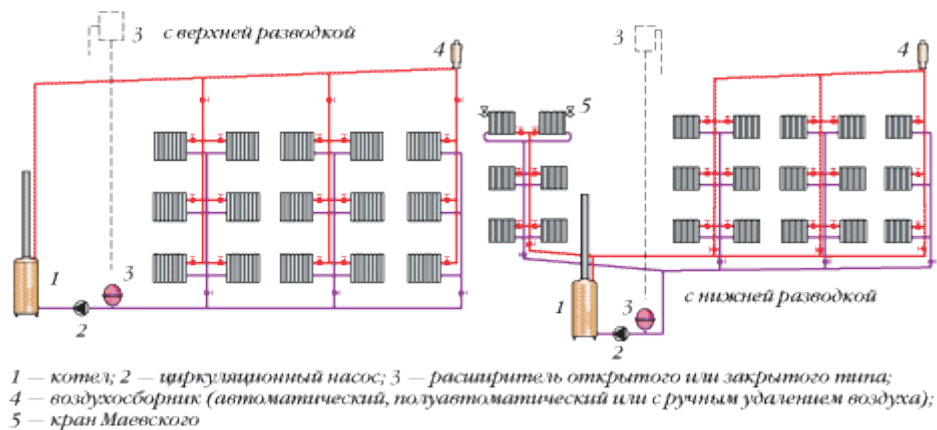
Схемы двухтрубных систем отопления с насосной циркуляцией воды с верхней и нижней разводкой подающего трубопровода
